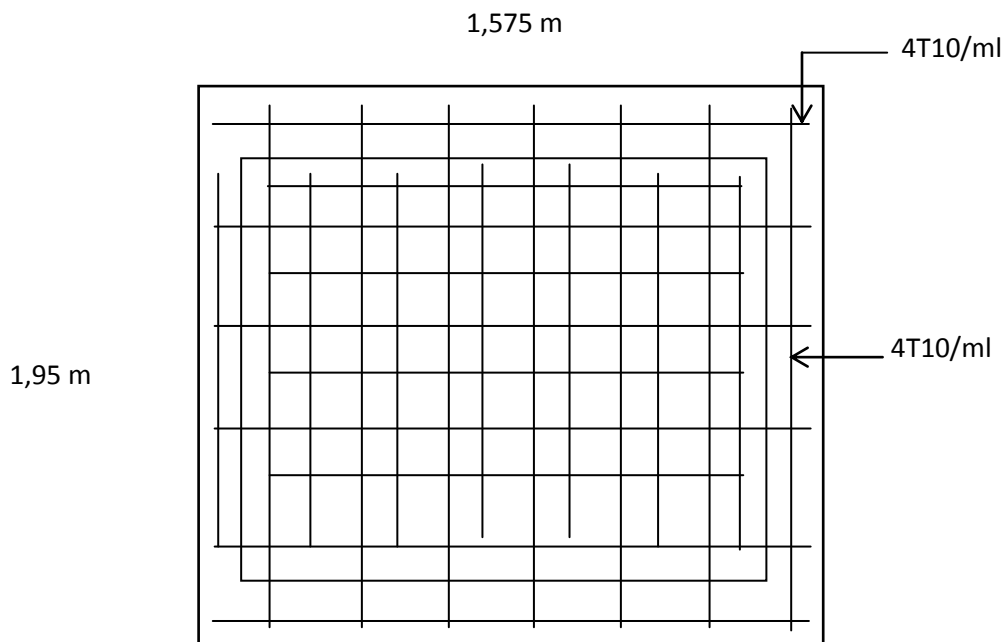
Ferrailage inférieur de la dalle de l'ascenseur
